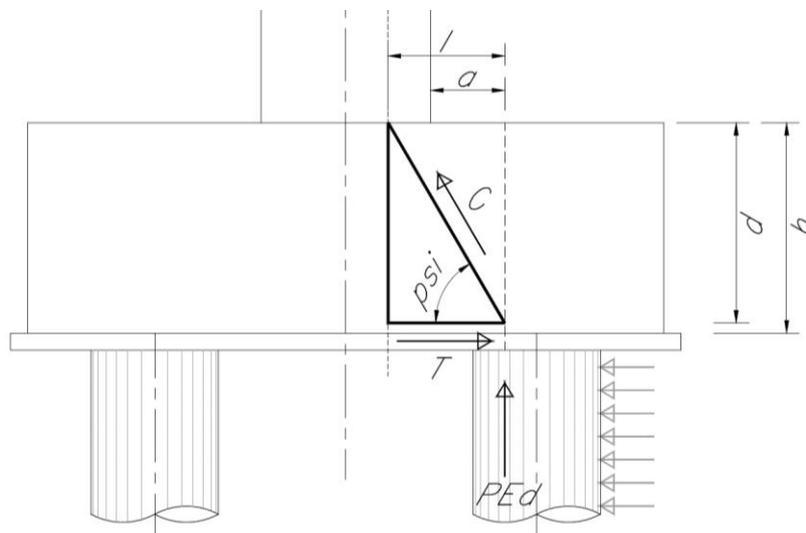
Tirante puntone - Biella compressa di calcestruzzo C e tirante di armatura T
